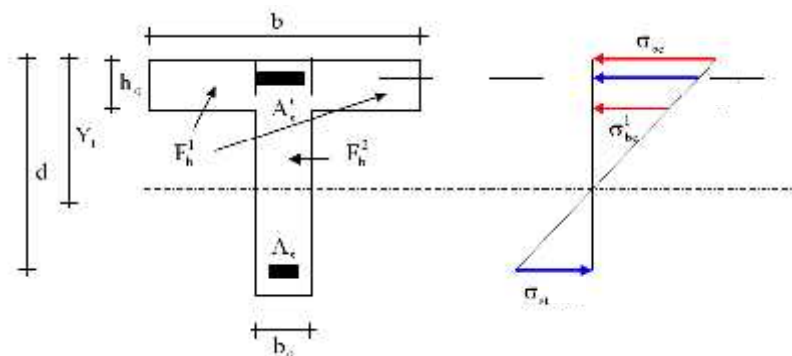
Figure III. : notation utilisées pour le calcul de section d'acier pour une poutre en T
